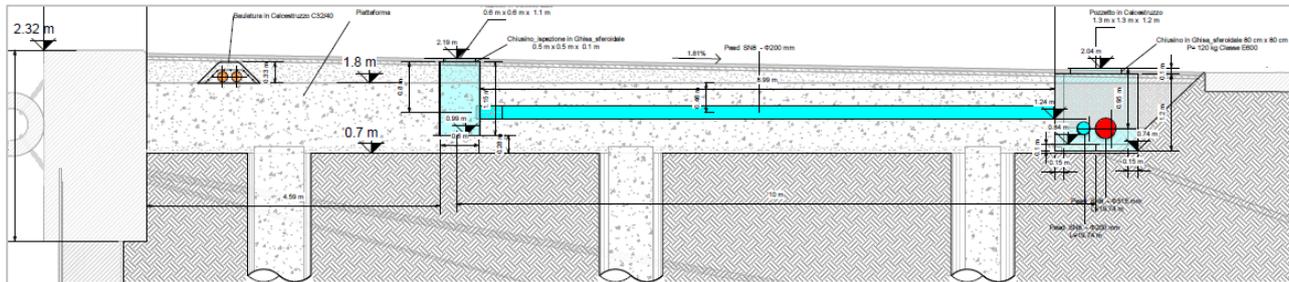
Sezione tipo predisposizione stacco acqua potabile
